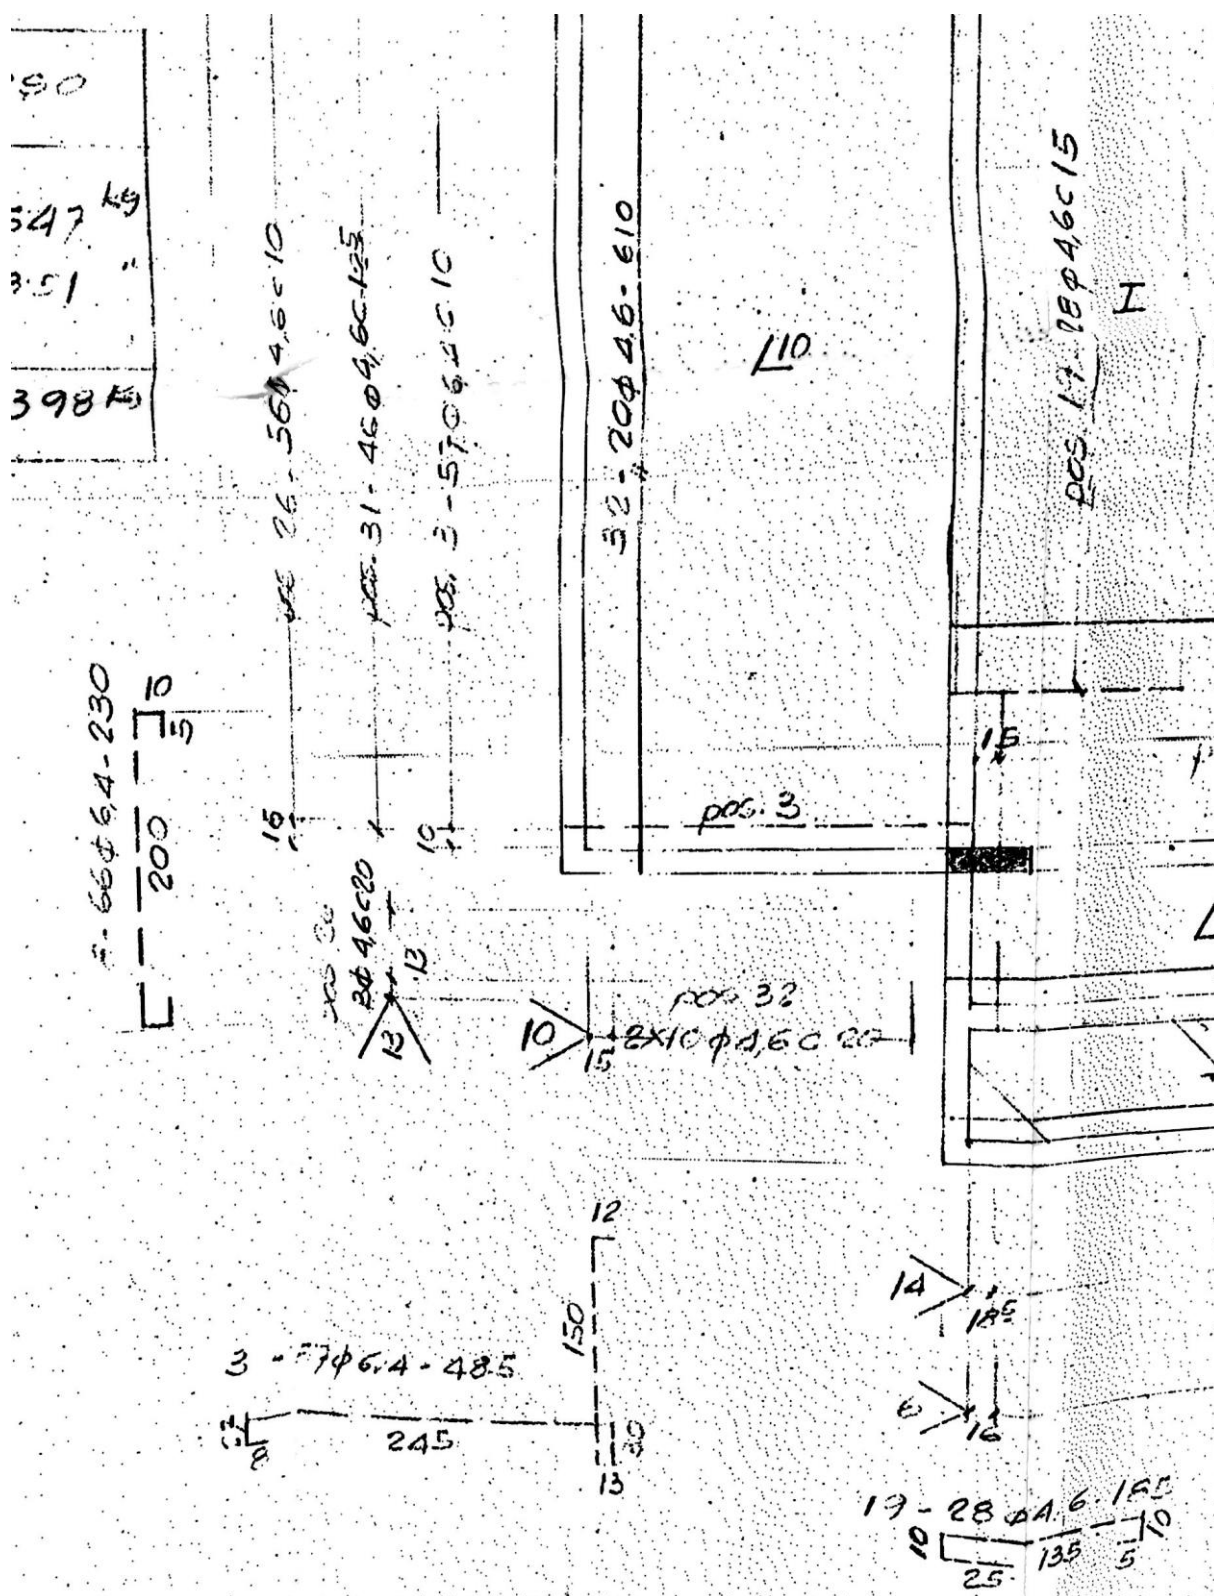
Reprodução Parcial da Armação das lajes da Cobertura
